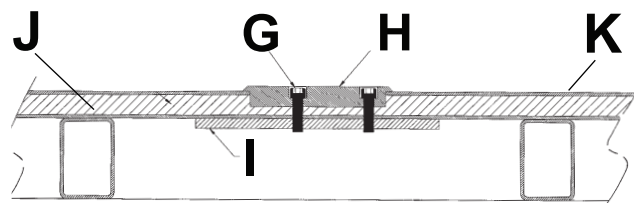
Ancoraggio delle piastre a pavimento nelle aperture incassate
